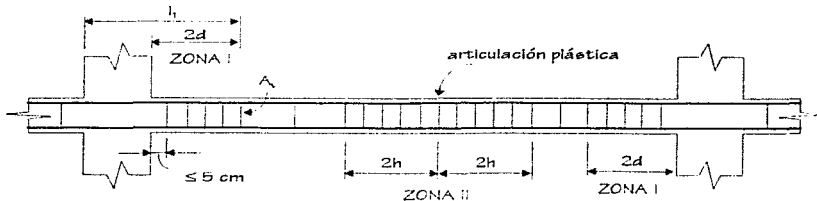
Requisitos para refuerzo transversal en vigas
